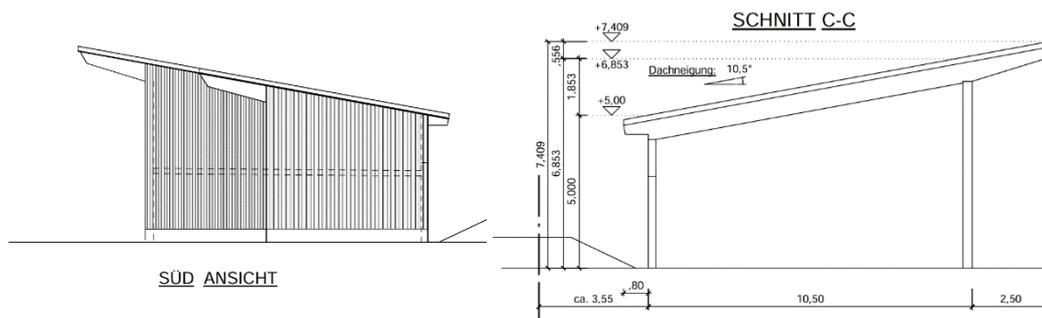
Offenes Schlepptdach an südöstlicher Grenze o.M. (Römmelt Hallenbau)
